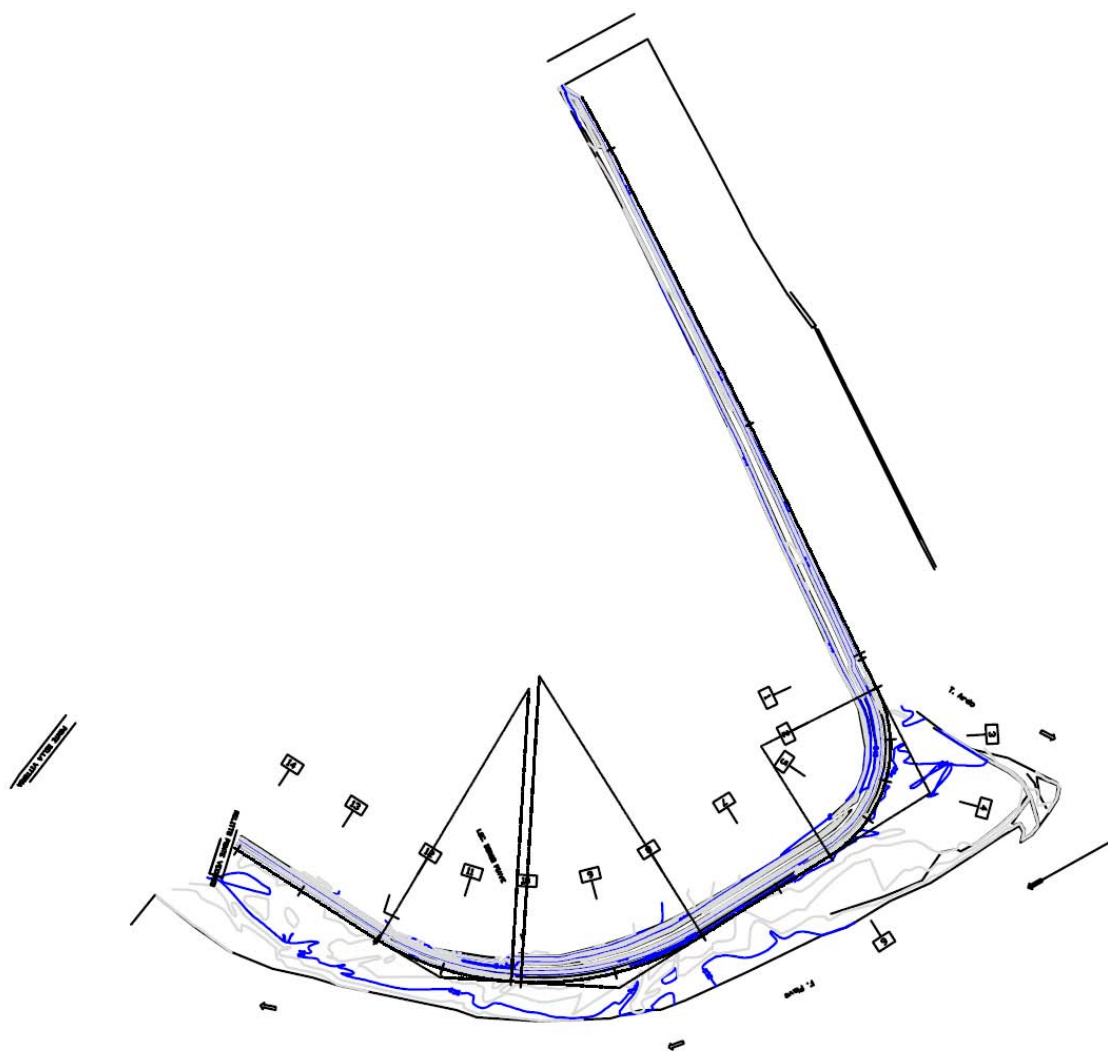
Planimetria di progetto dell'intervento alla confluenza Ardo-Piave a Belluno.
